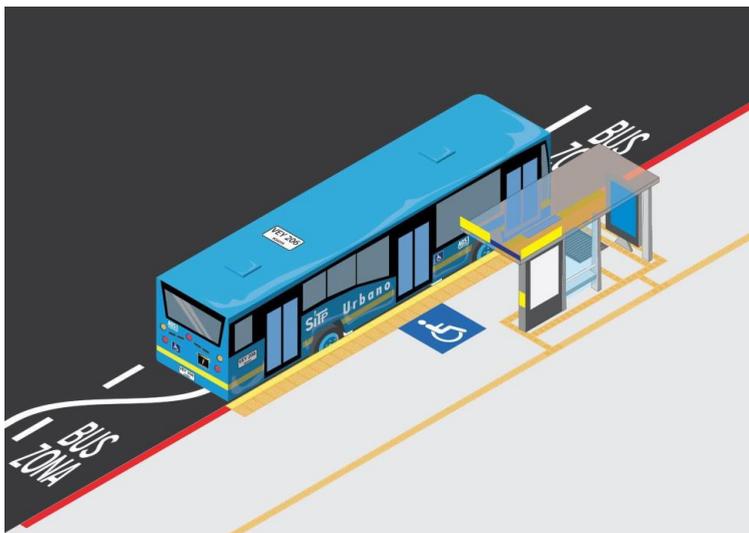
Proyección paradero con Configuración Tipo A - genérico.
